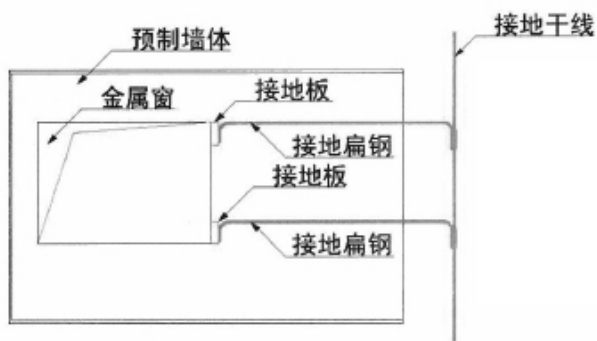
预制外墙门窗的接地板在预制外墙内的安装方式平面图
